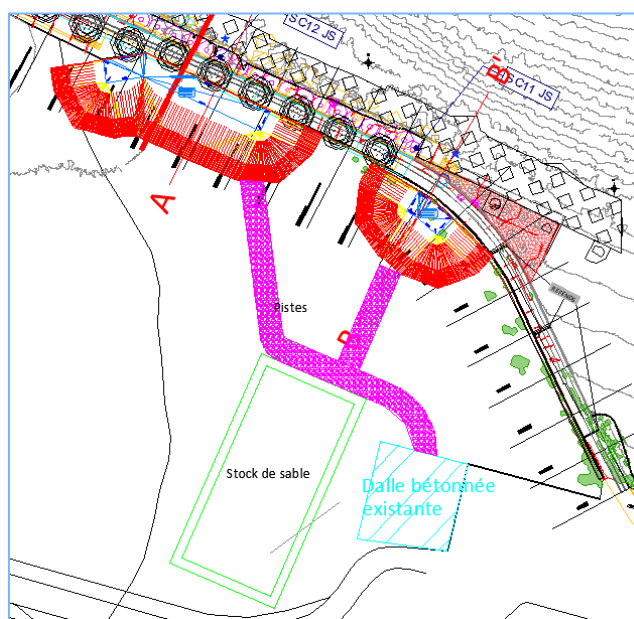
Plan de masse de la piste pour l'accès à la zone de stockage
